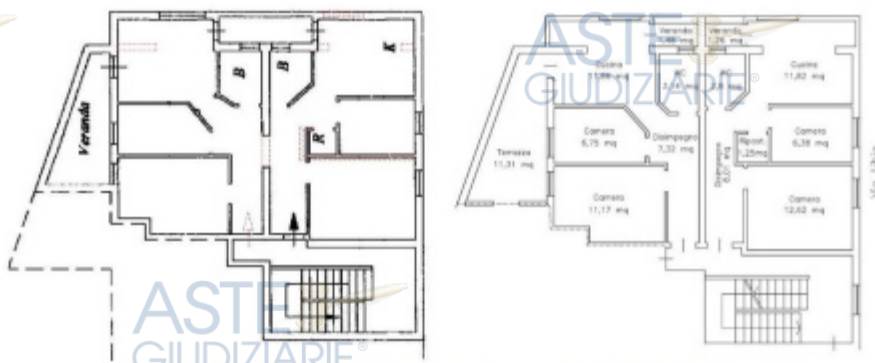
Raffronto tra planimetria catastale (a sinistra) e stato dei luoghi (a destra).
